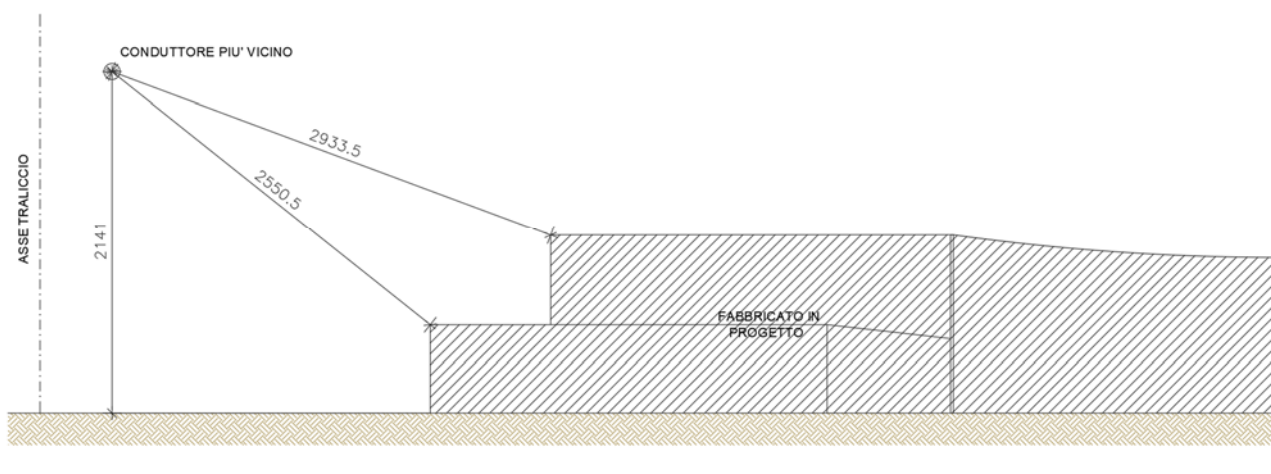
Sezione ortogonale all'asse linea con indicazione della distanza tra i punti dell'estradosso del fabbricato in progetto ed il conduttore più vicino.
